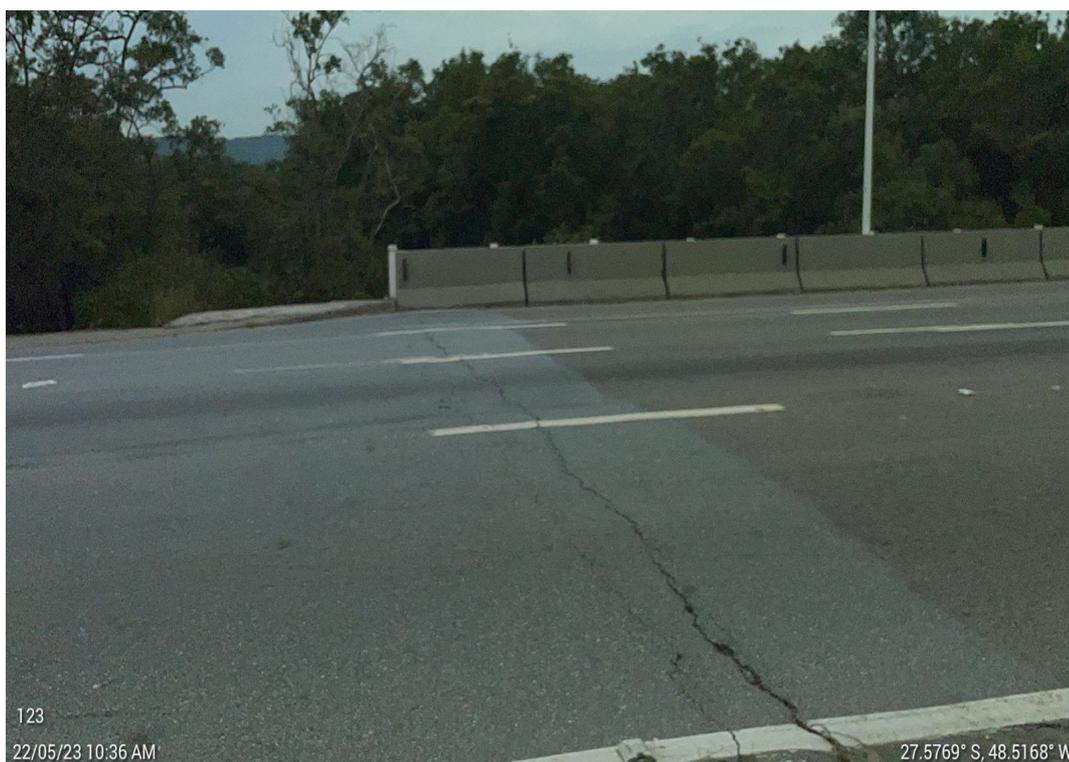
Superestrutura – Tabuleiro Pavimento com junta de encontro encoberta por CBUQ e fissurada.
